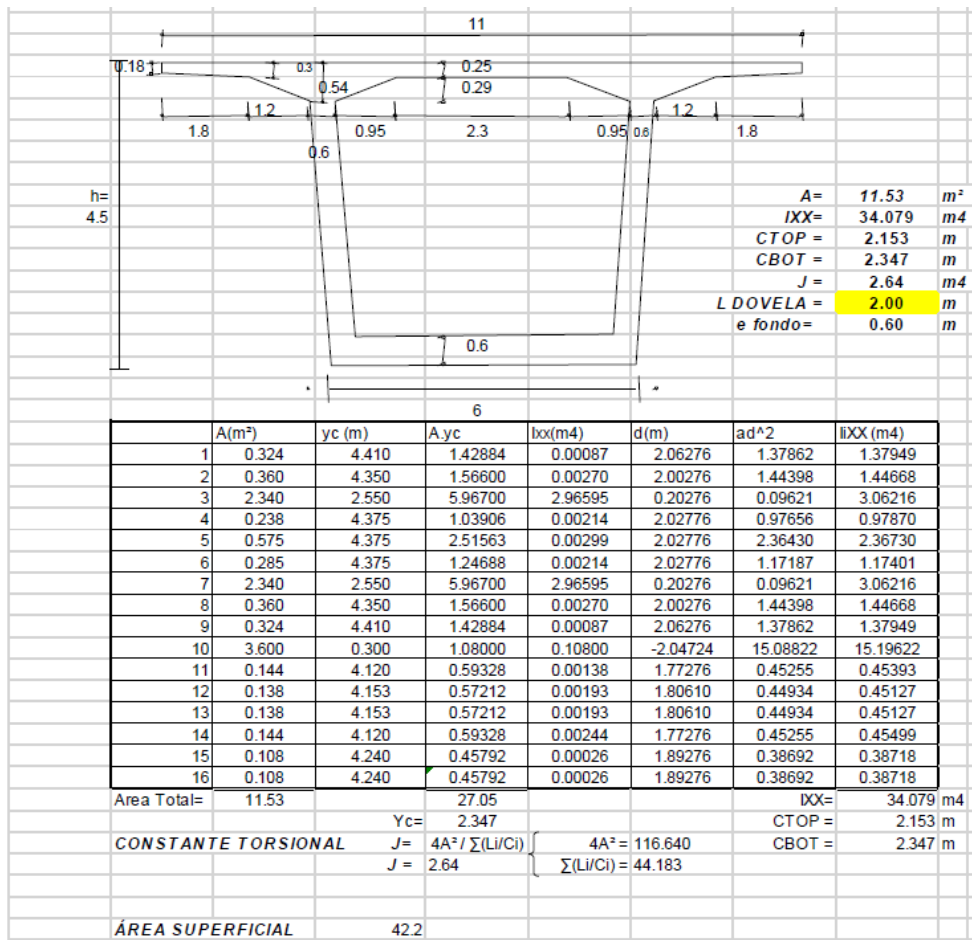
Dimensiones y propiedades de la viga cajón cara de pila puente San Pedro.
